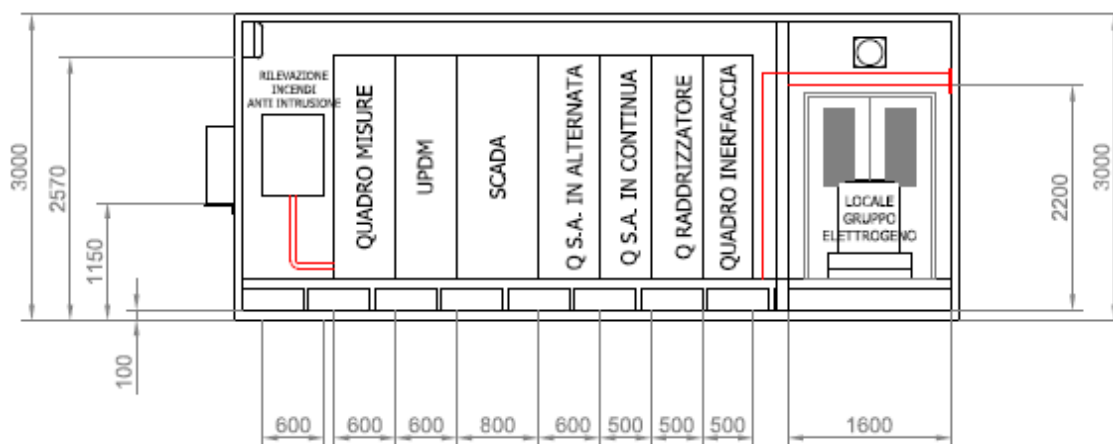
Prospetto locale BT in Cabina di Consegna utente
